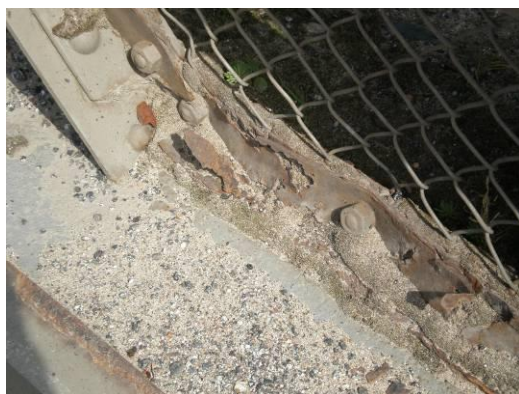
Pormenor da corrosão das cantoneiras de ligação das guardas do passeio
